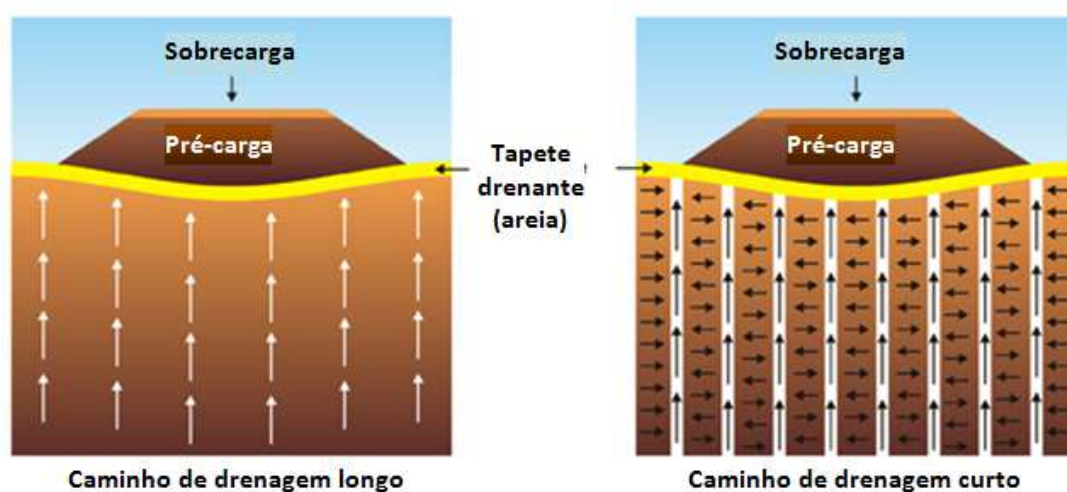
Percolação num estrato homogêneo, sujeito a consolidação por aplicação de um aterro de pré-carga, sem drenos e com drenos verticais (imagem retirada de <http://www.retech.in/prefa.html>, em Janeiro de 2013)
